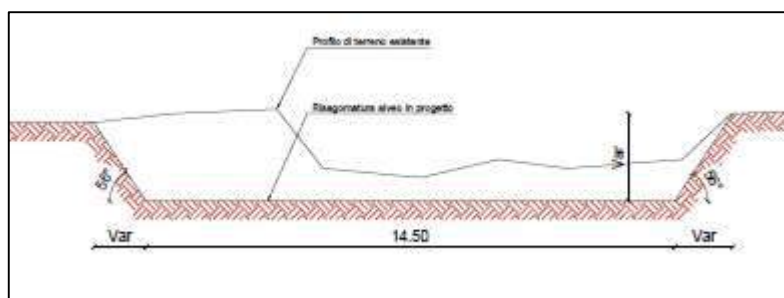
Sezione tipologica sistemazione alveo in progetto
